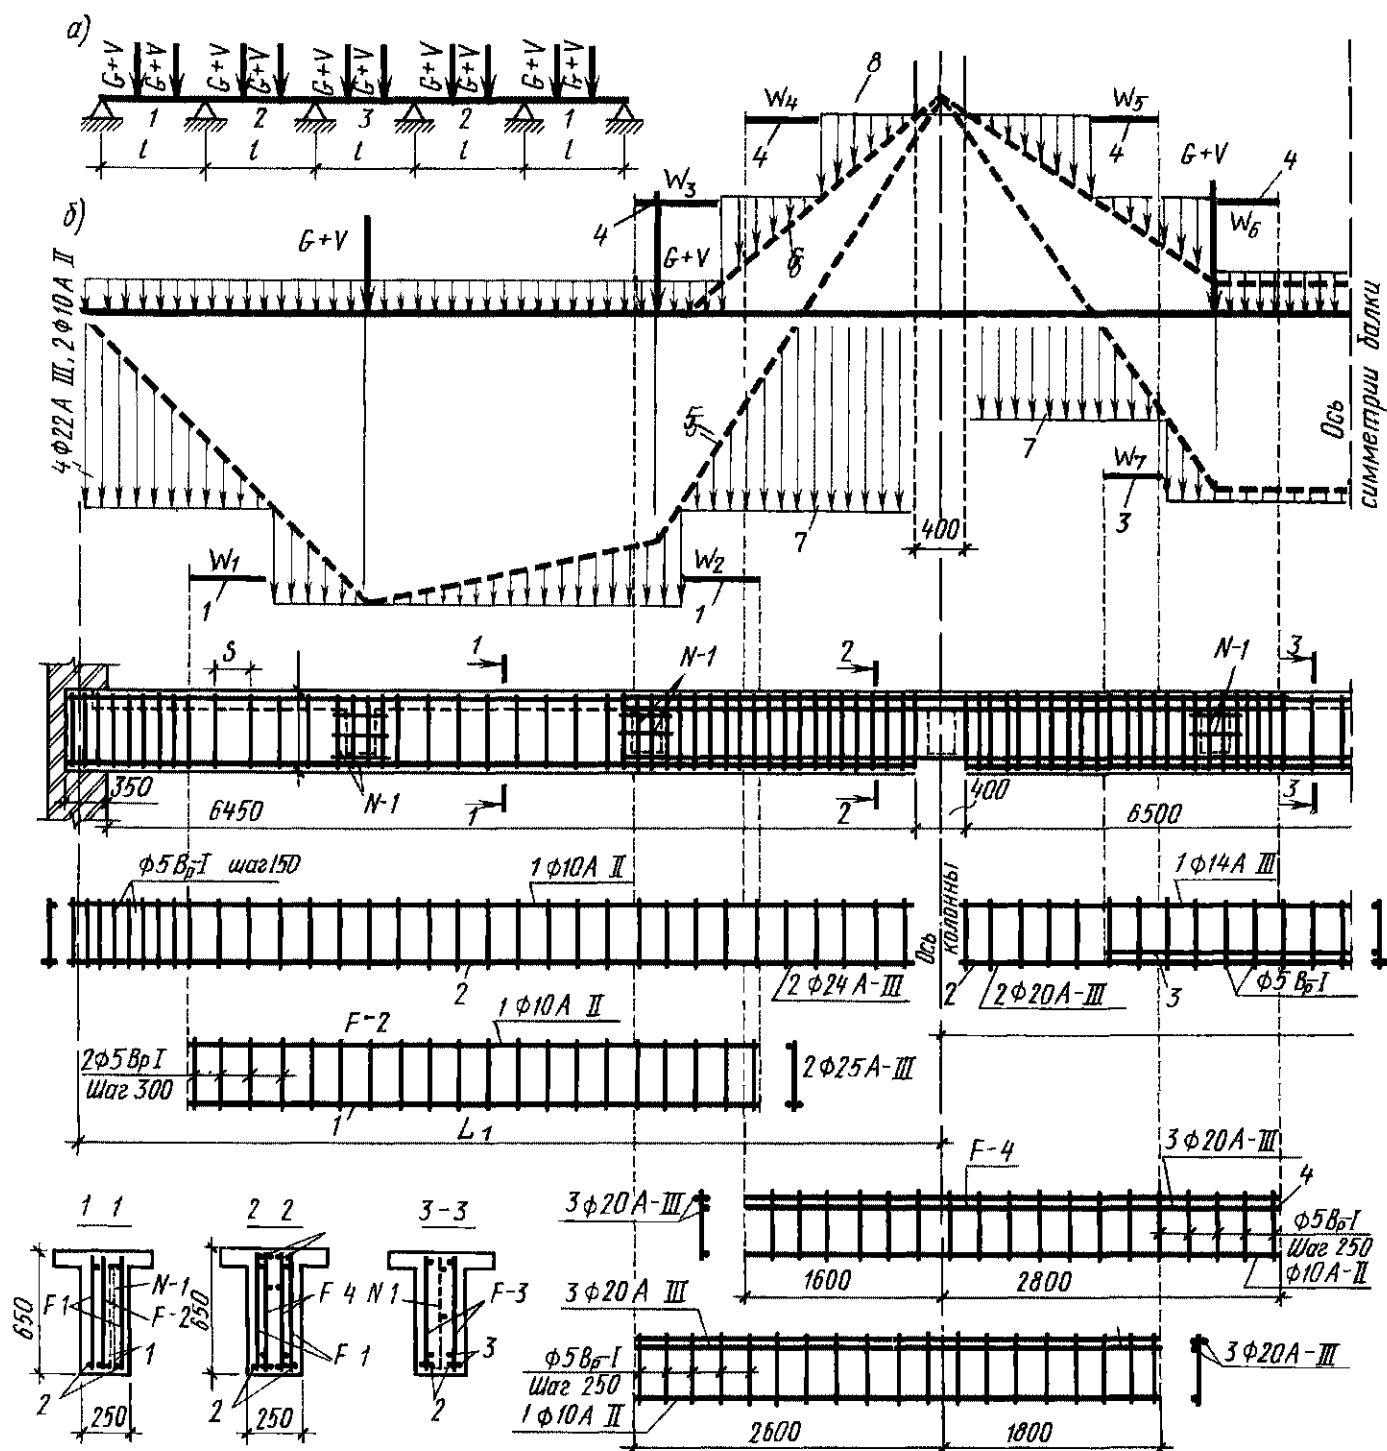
Армирование главных балок плоскими сварными каркасами
